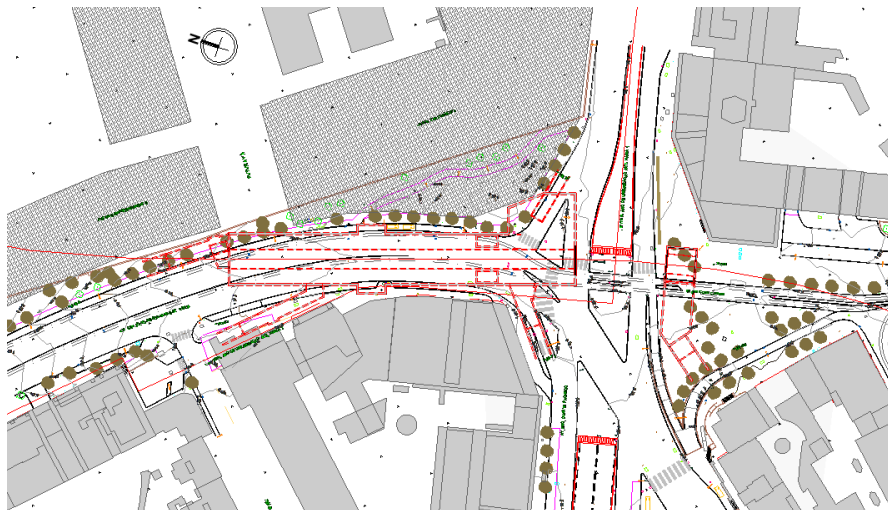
Planta de Implantação da Estação Campolide Amoreiras
